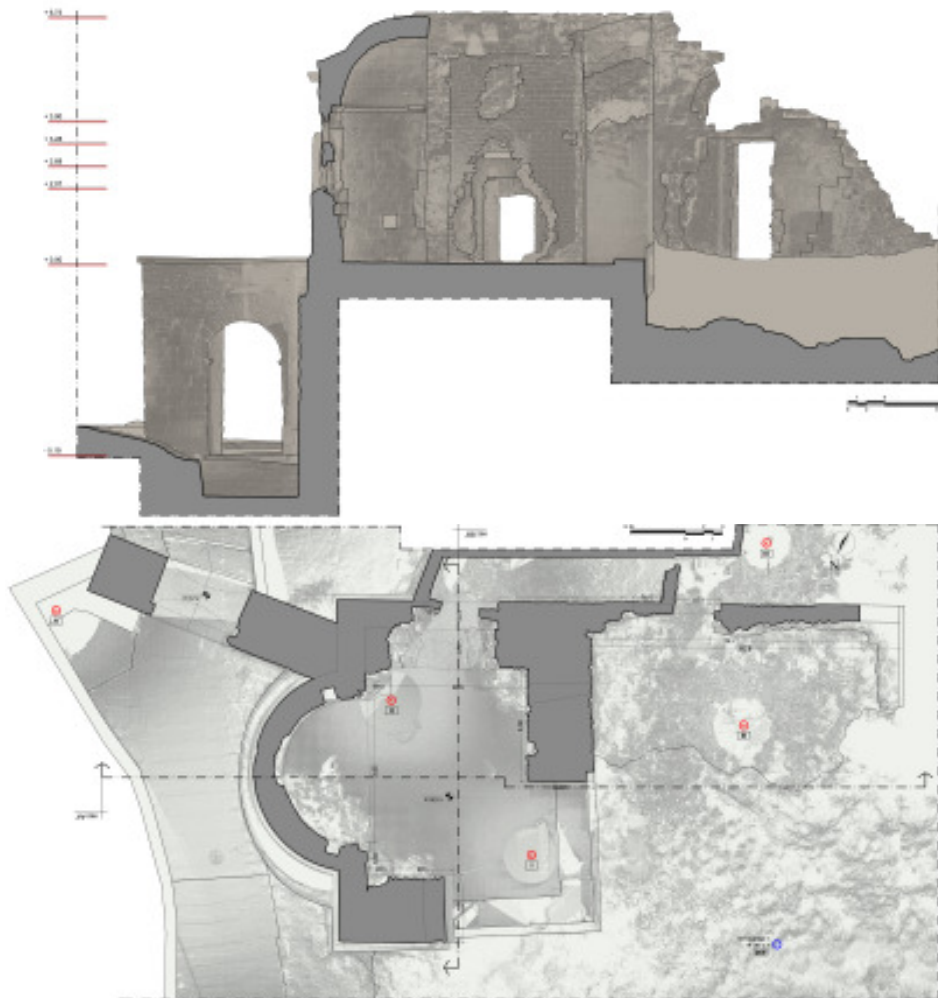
Pianta e sezione dei lacerti della rocca.
